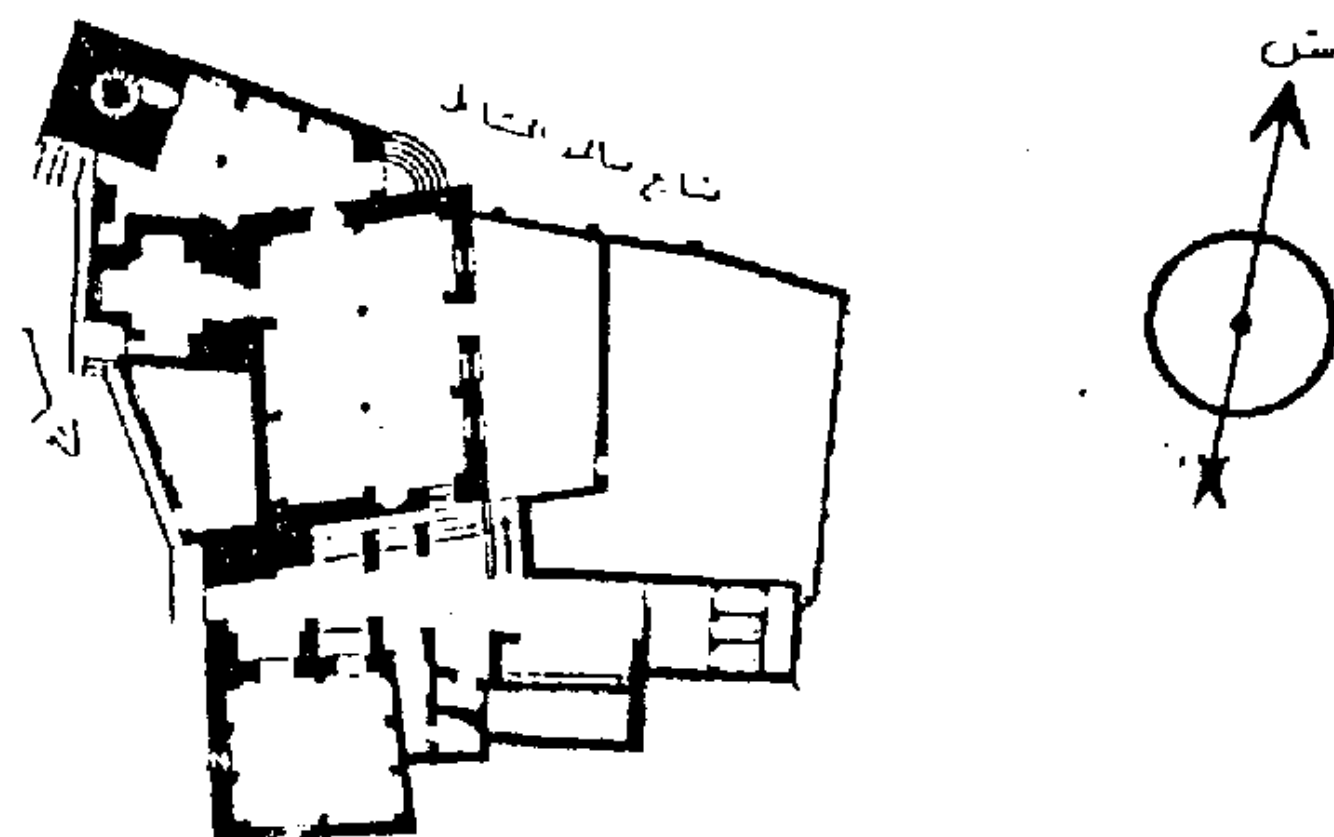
مسقط أفقي لمسجد ميفارقين عن أصلان آبا.
